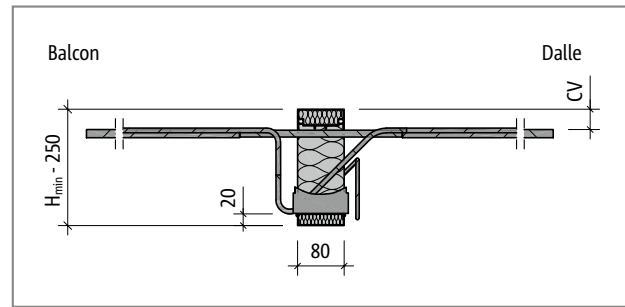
Schöck Isokorb® T Type K-E-M8 : Coupe du produit
